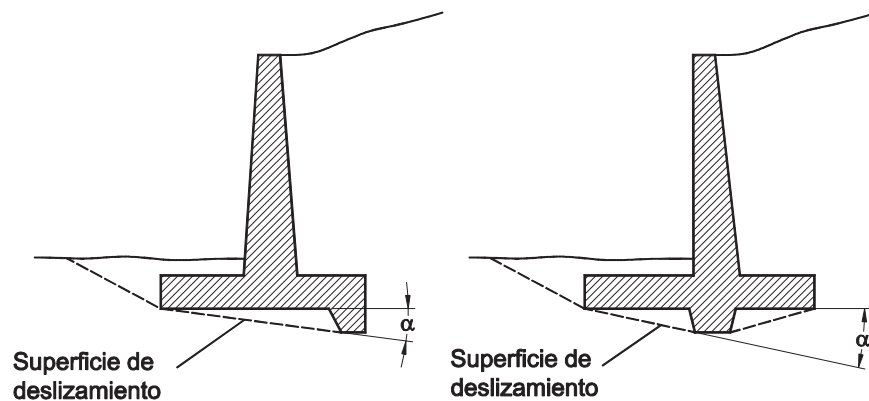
Posibles superficies de deslizamiento en muro con zarpa
